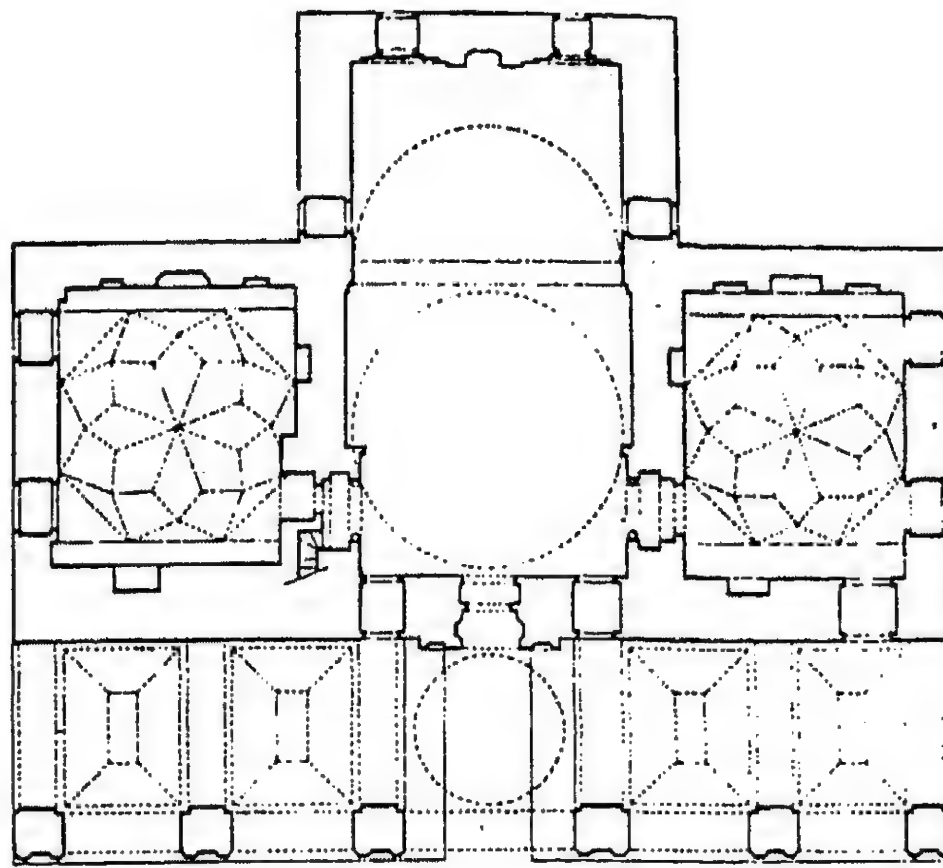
مسقط أفقي لمسجد الفاتحية الصغير في أثينا (عن : اصلان ابا)
